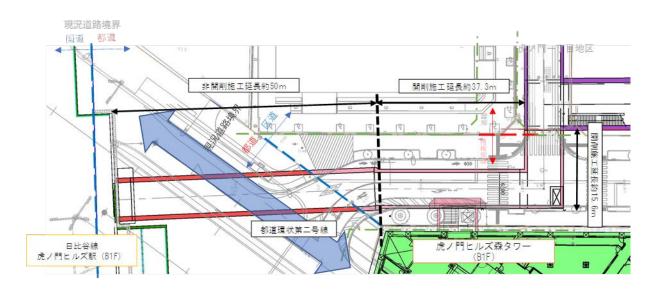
地下歩行者通路(東京メトロ施工監理実施部分)平面図
